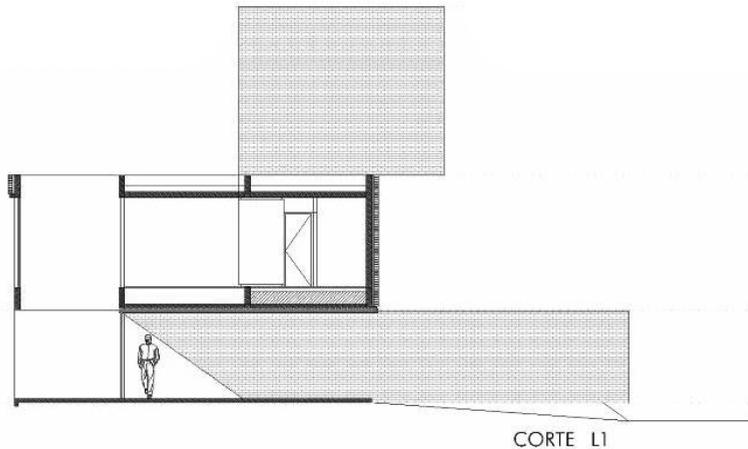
Planimetría: corte-vista de la Casa de la Cruz, Rafael Iglesias, Rosario, 2006.
